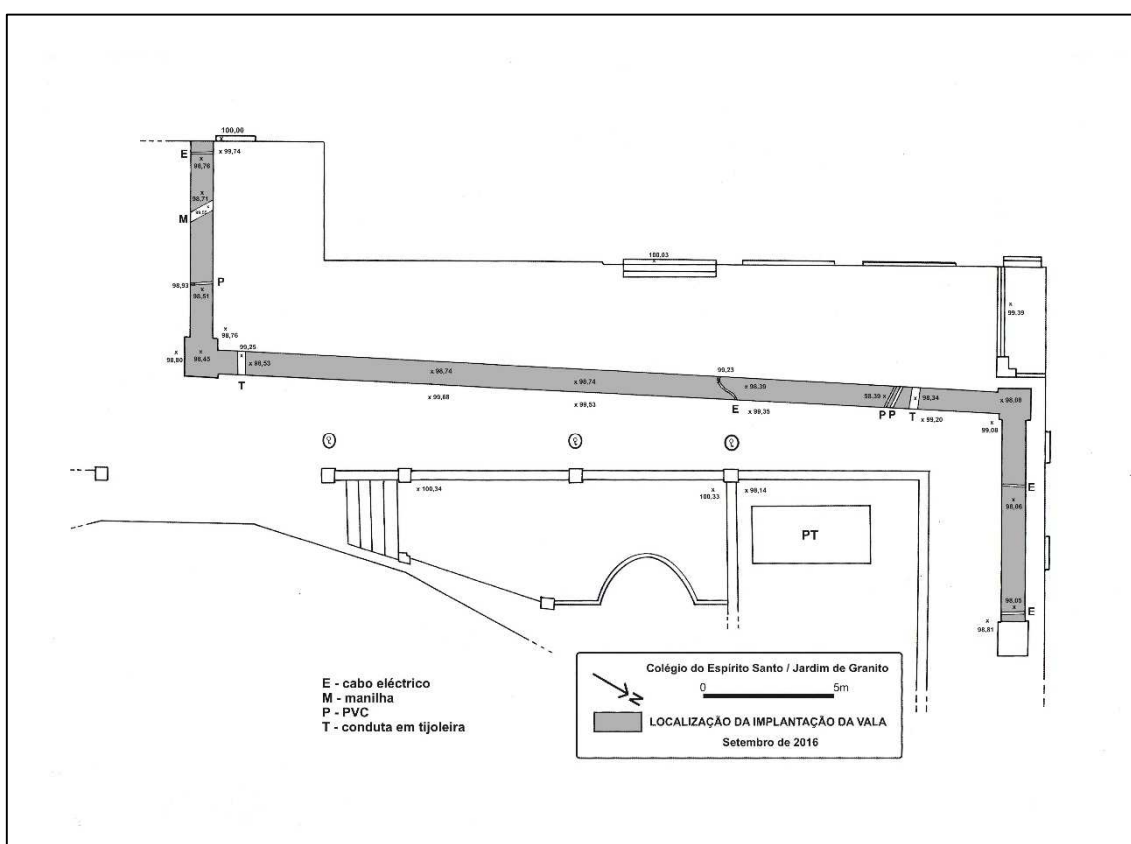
Planta final da obra (sgd. Oliveira e Rocha, 2016).
